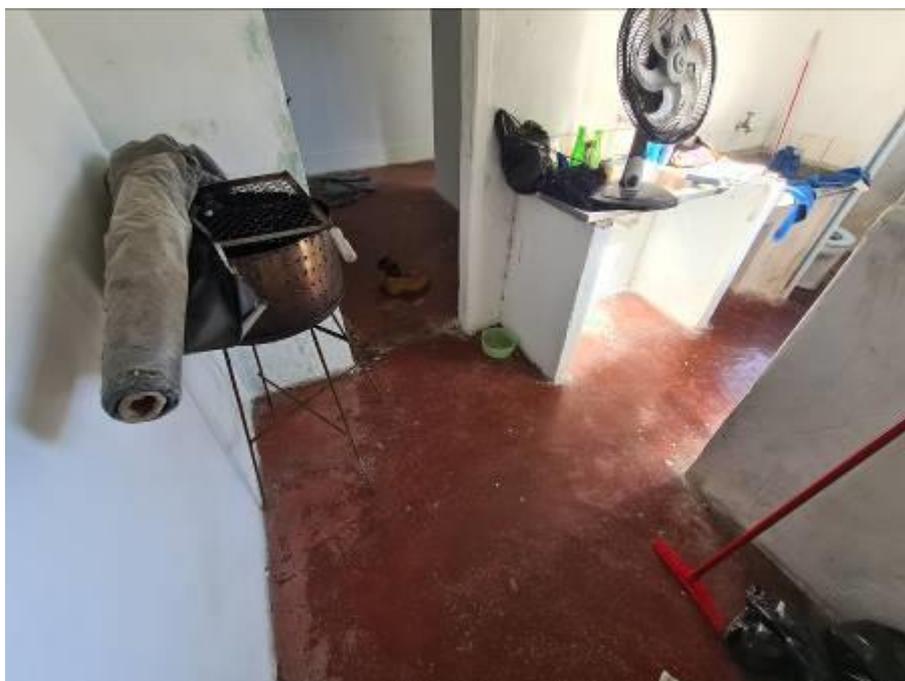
Vista da cozinha da quinta moradia, localizada no pavimento superior.
